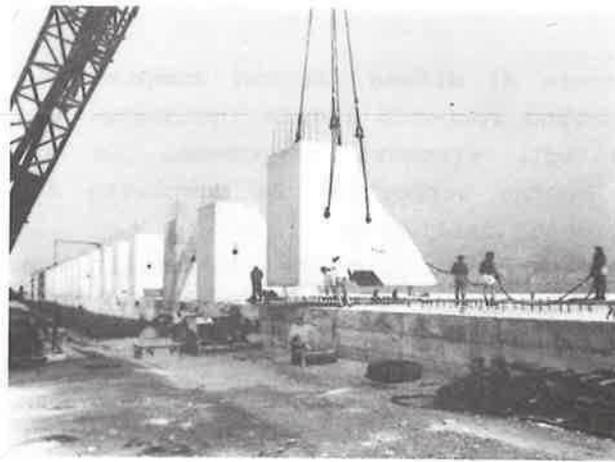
Sovrastruttura della Diga foranea del Porto di Voltri: posa del prefabbricato e getto di completamento
